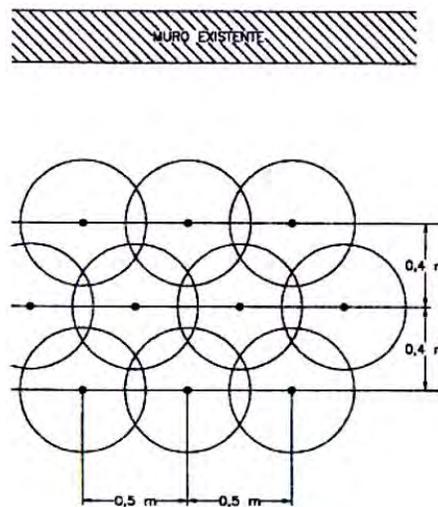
Esquema típico de columnas de jet grouting para una pantalla
